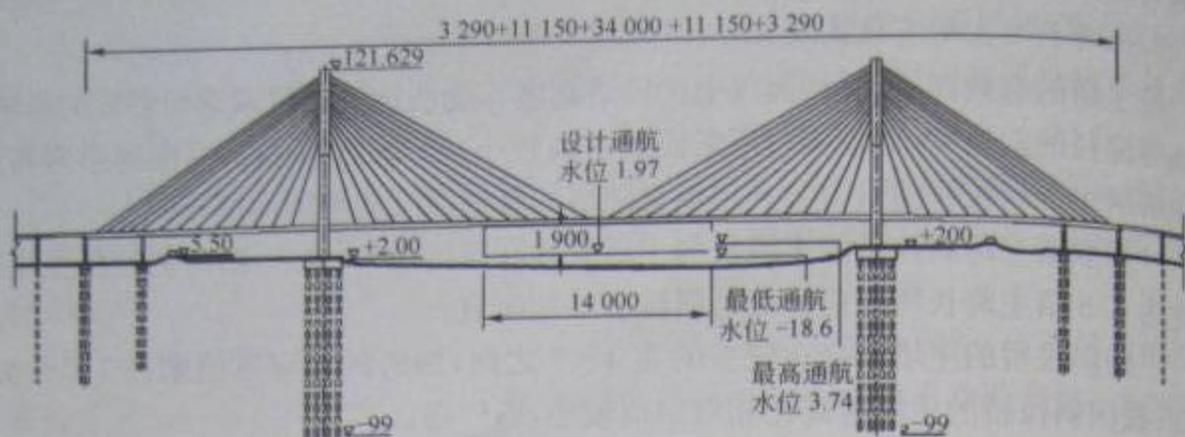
灌河大桥桥跨布置图(尺寸单位:cm)
